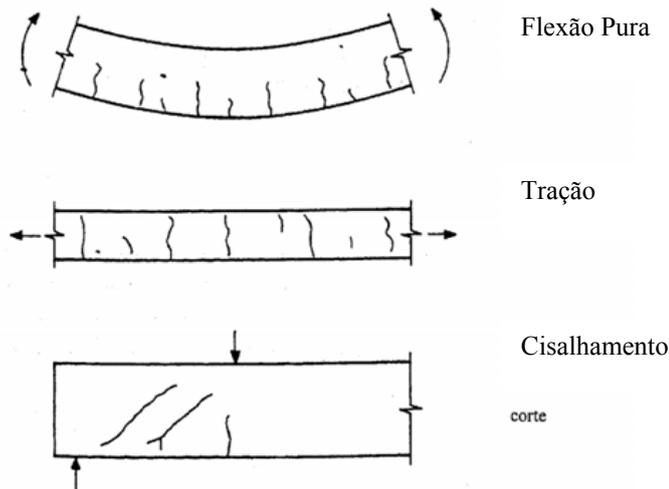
Fissuras características da sobrecarga. Fonte: Coutinho (1998)
